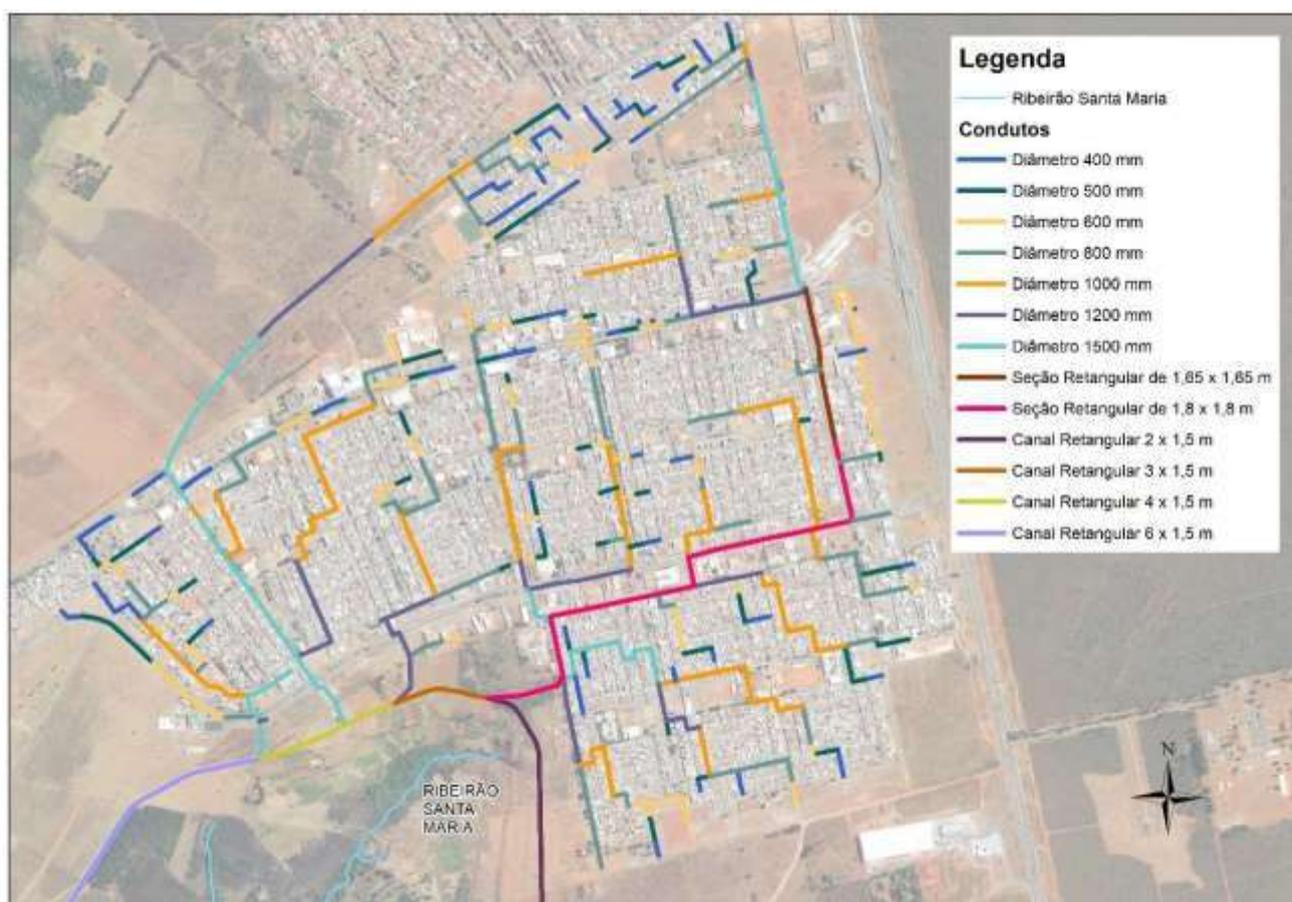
Dimensões das tubulações da rede de drenagem urbana cadastrada em Santa Maria.
